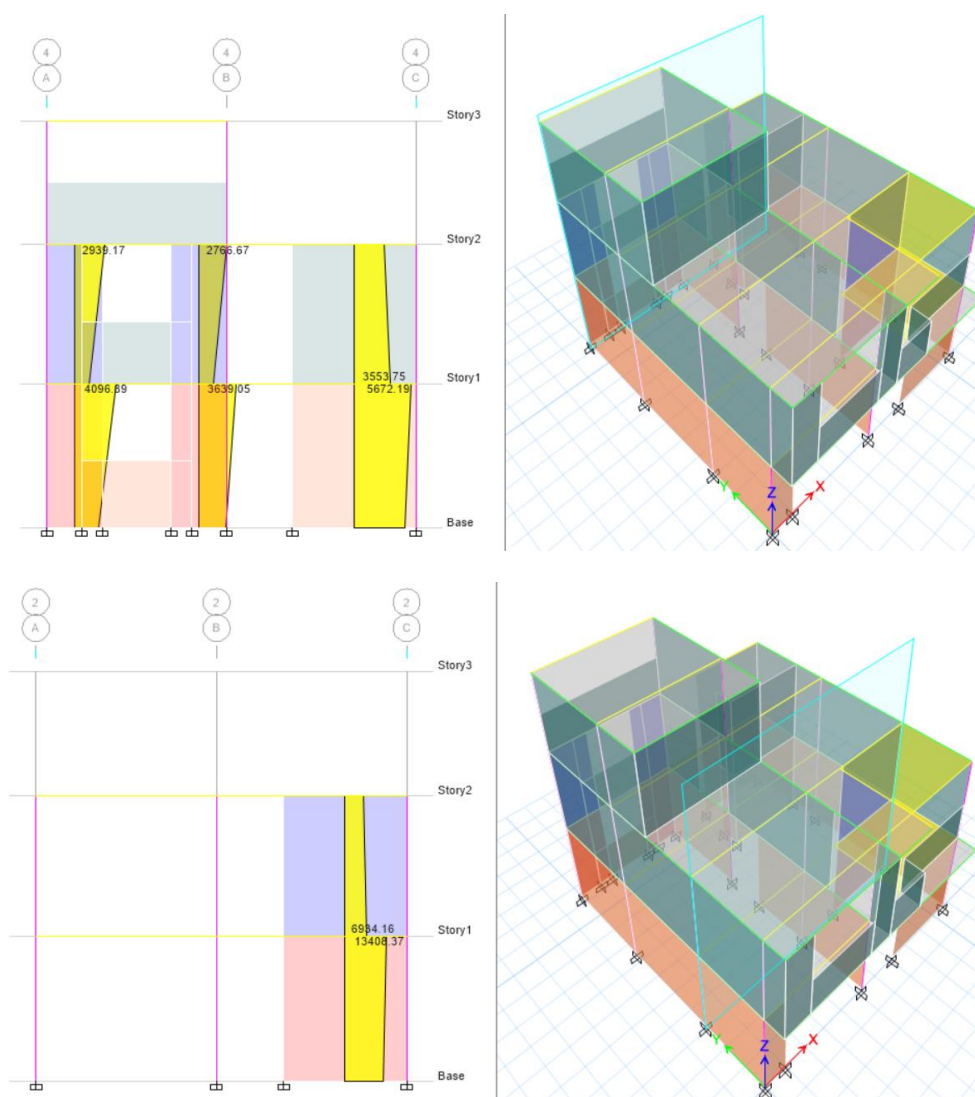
Fuerza sísmica tomada por el muro del eje 4-4 y el eje 2-2, de la vivienda con refuerzo.
